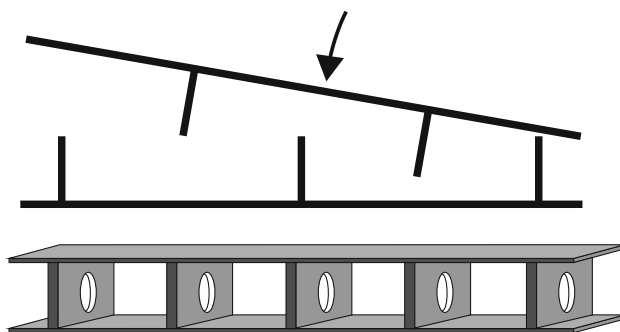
Фрагмент трехслойной сталежелезобетонной плиты с листовыми стальными обшивками [18]
